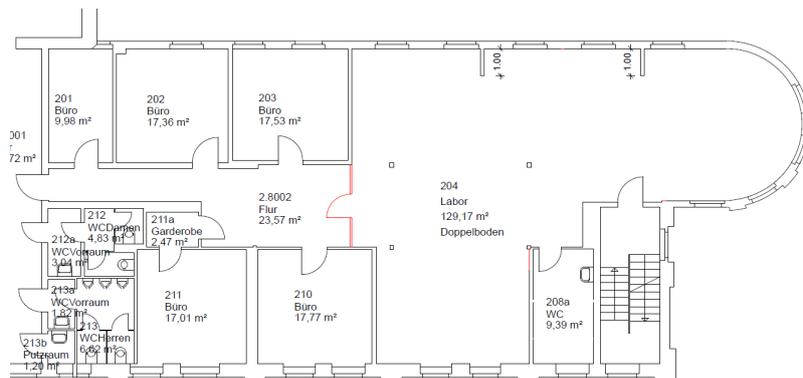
Grundriss des Living Place Hamburg
